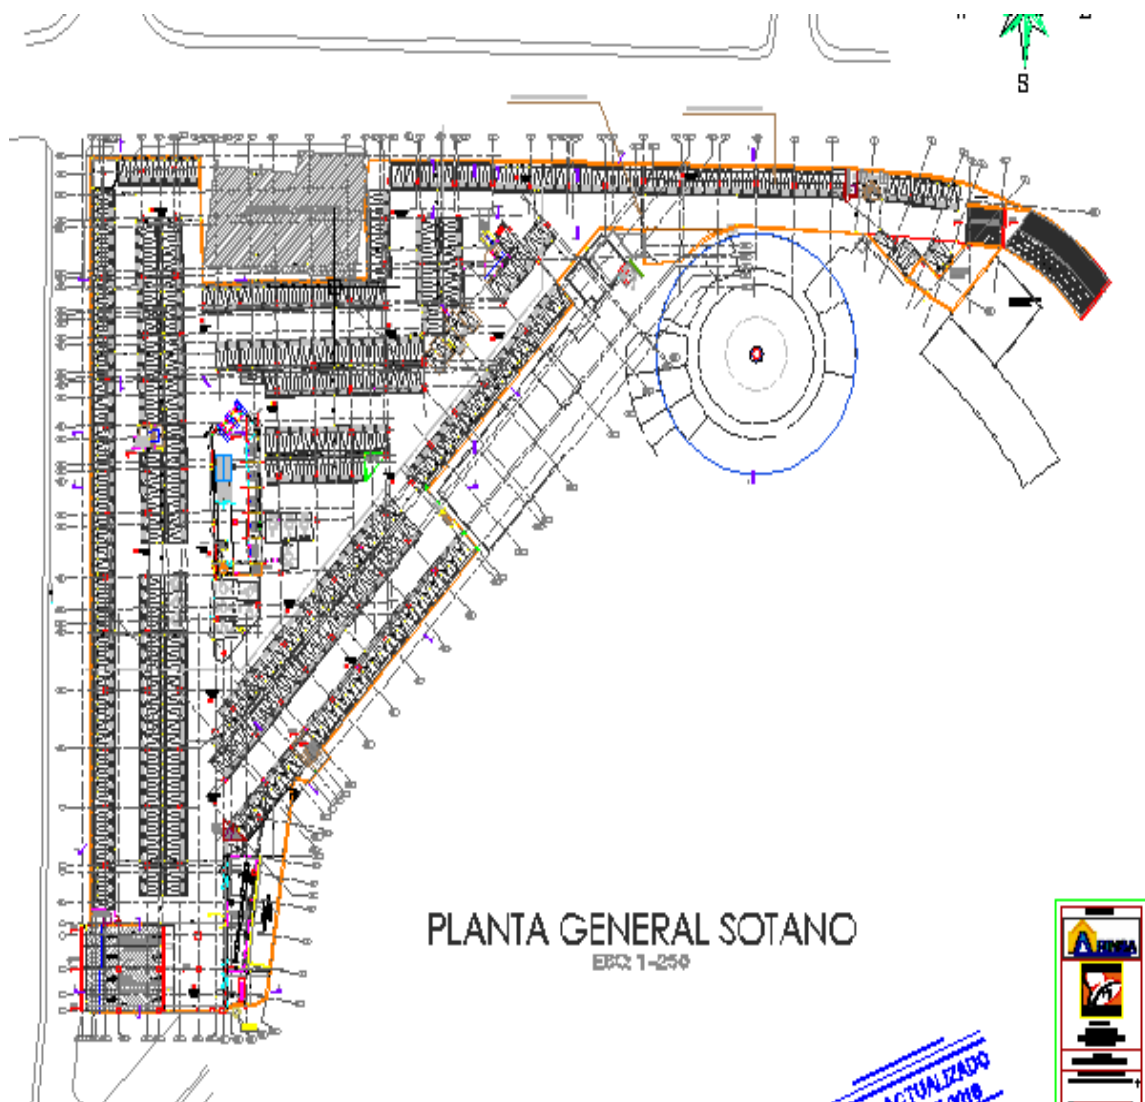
Planta arquitectónica de sótano (Fuente: Diseños arquitectónicos ARINSA)
